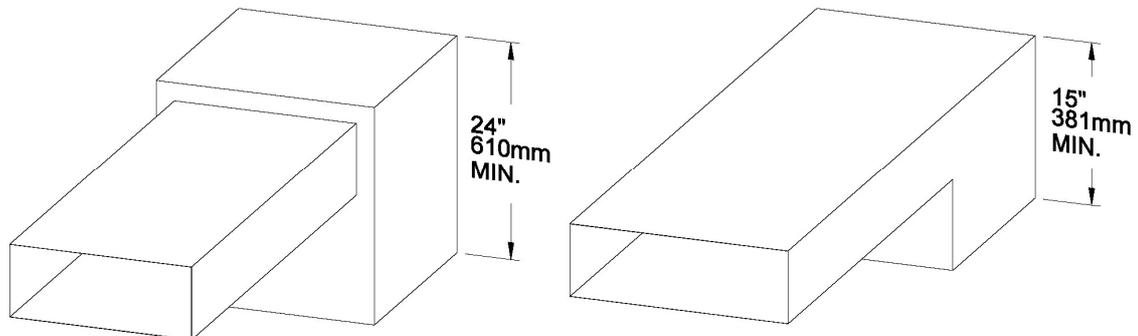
b - Hauteur minimale du plénum d'air chaud.
